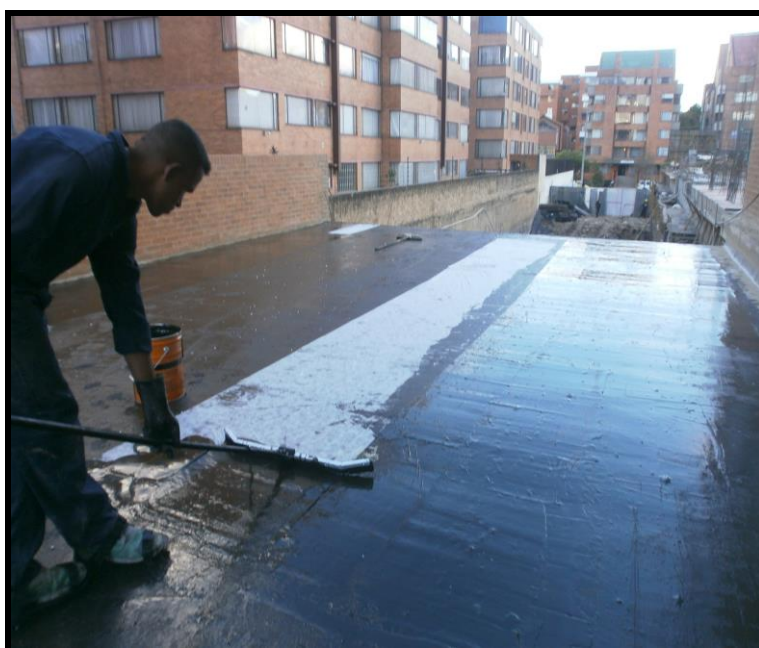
La tela poliéster debe quedar bebida entre capas. Fuente: construcción de los autores
